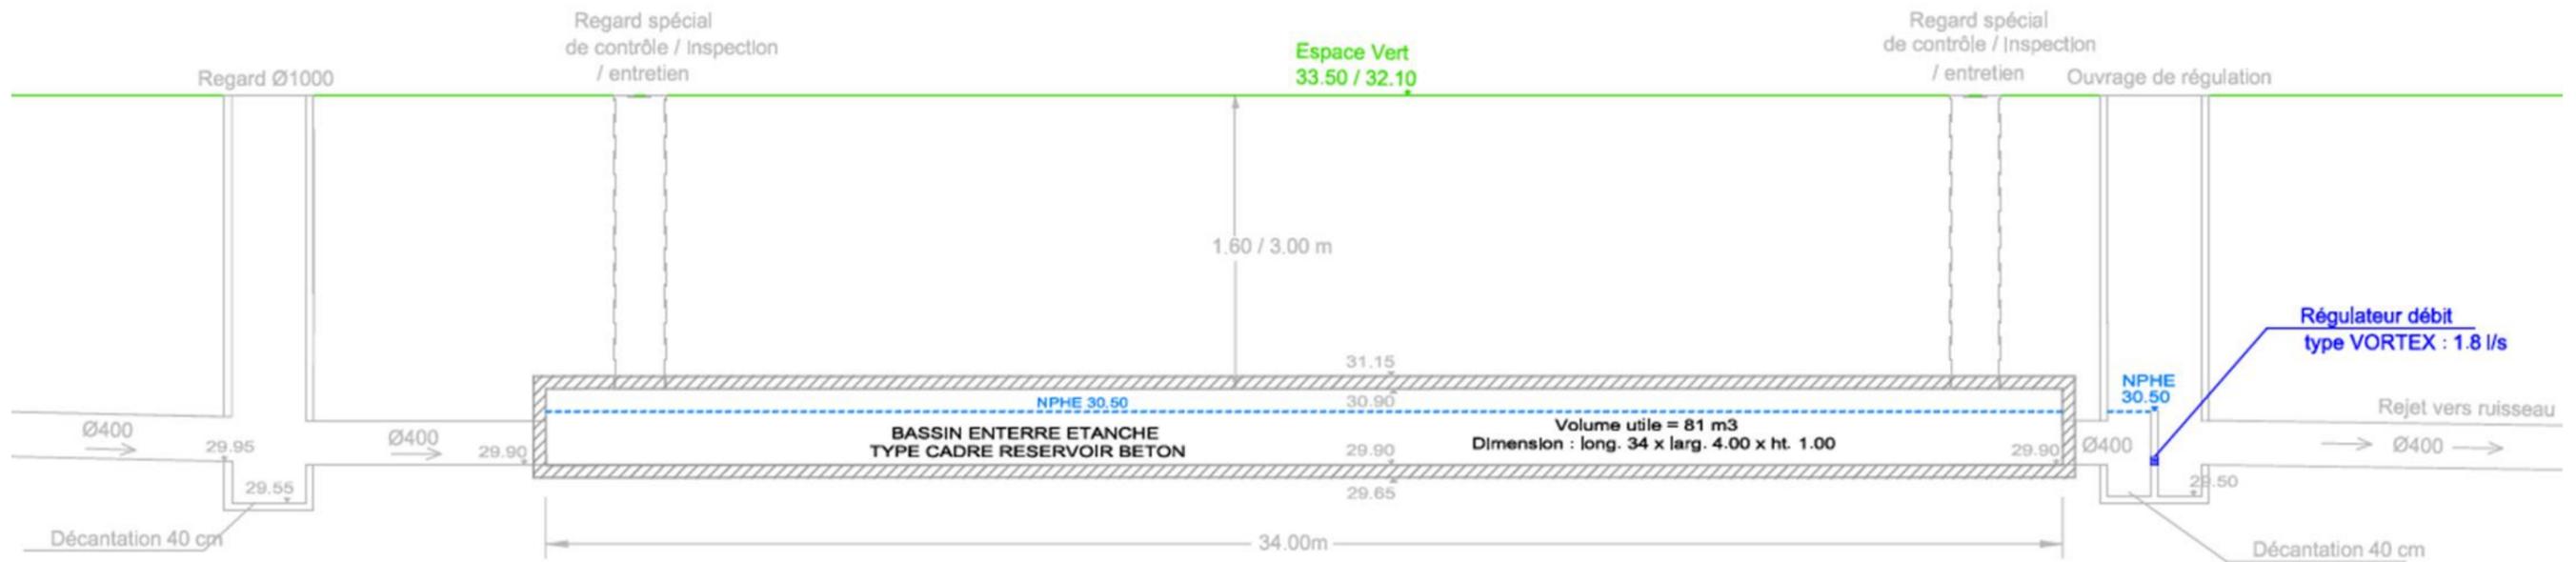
SCHEMA DE PRINCIPE DU BASSIN ENTERRE ETANCHE TYPE CADRE RESERVOIR BETON
